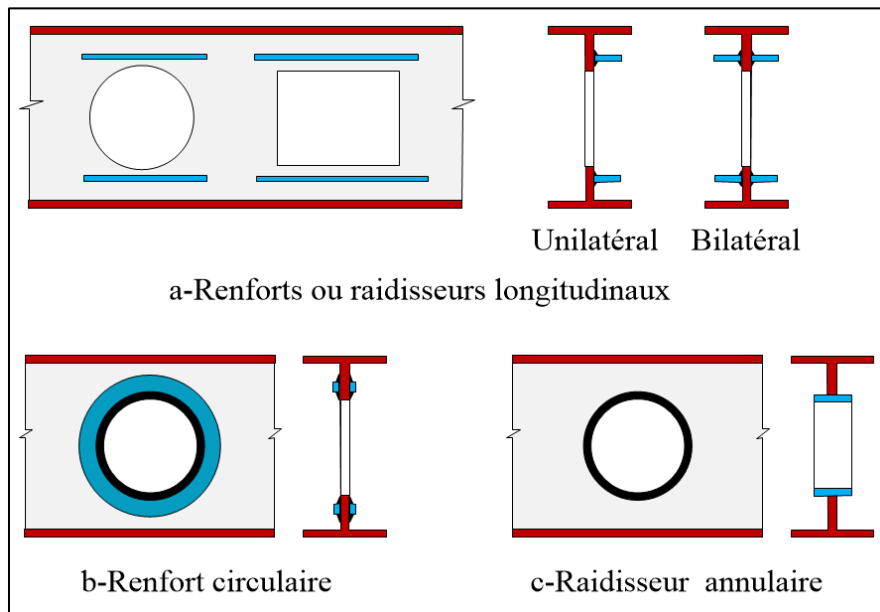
Raidissage ou renforcement des ouvertures d'âme[7]
